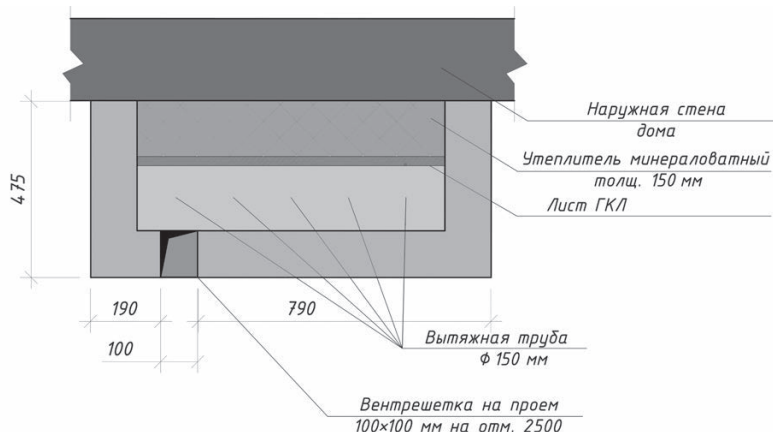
Устройство примыкания вытяжных каналов к наружной стене
